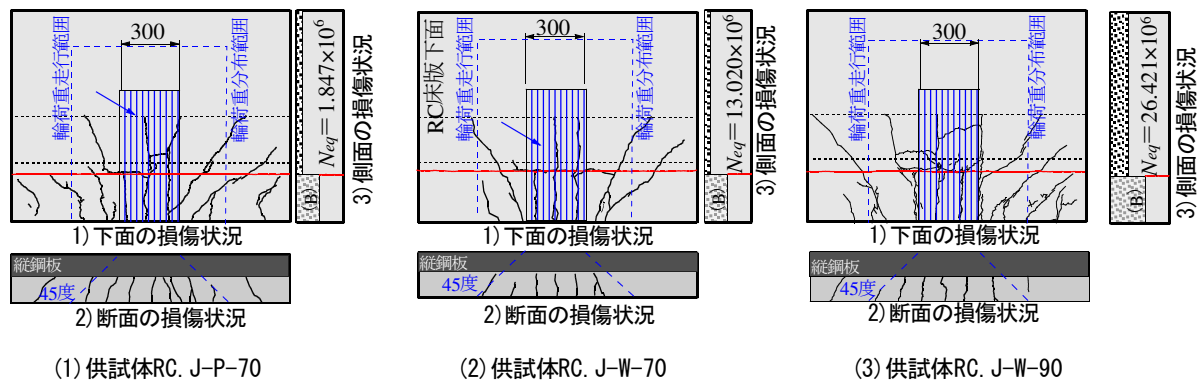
伸縮装置のたわみ4.0mmに達した時点のひび割れ状況
